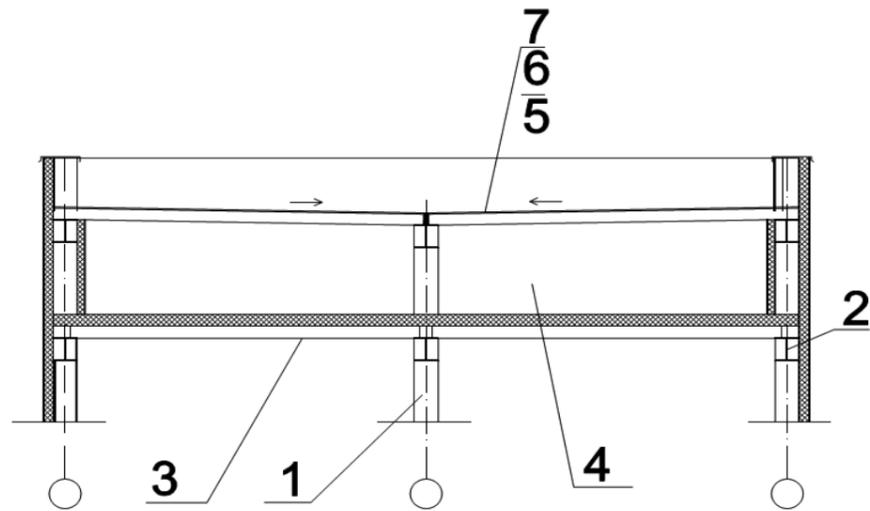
Схема кровли с внутренним водоотводом с применением многопустотных плит перекрытий. 1- колонна, 2-ригель, 3-плита перекрытия, 4- технический этаж, 5-плита покрытия, 6- стяжка, 7- гидроизоляционный ковер
